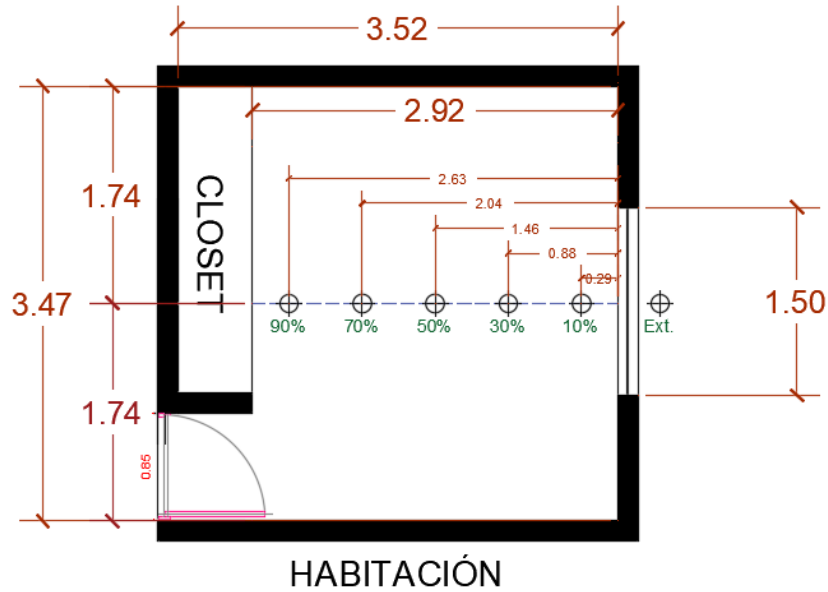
Planta arquitectónica con ubicación de puntos de medición. Fuente: elaboración propia del autor.
